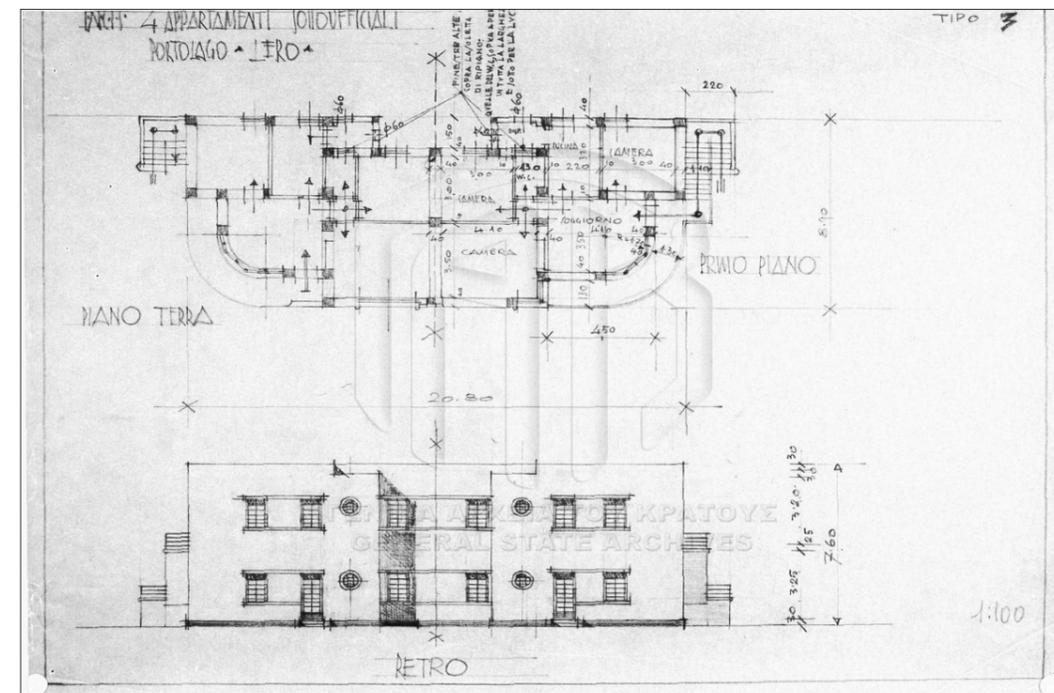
case sottufficiali 3, piante prospetto e sezione, sc. 1:100
